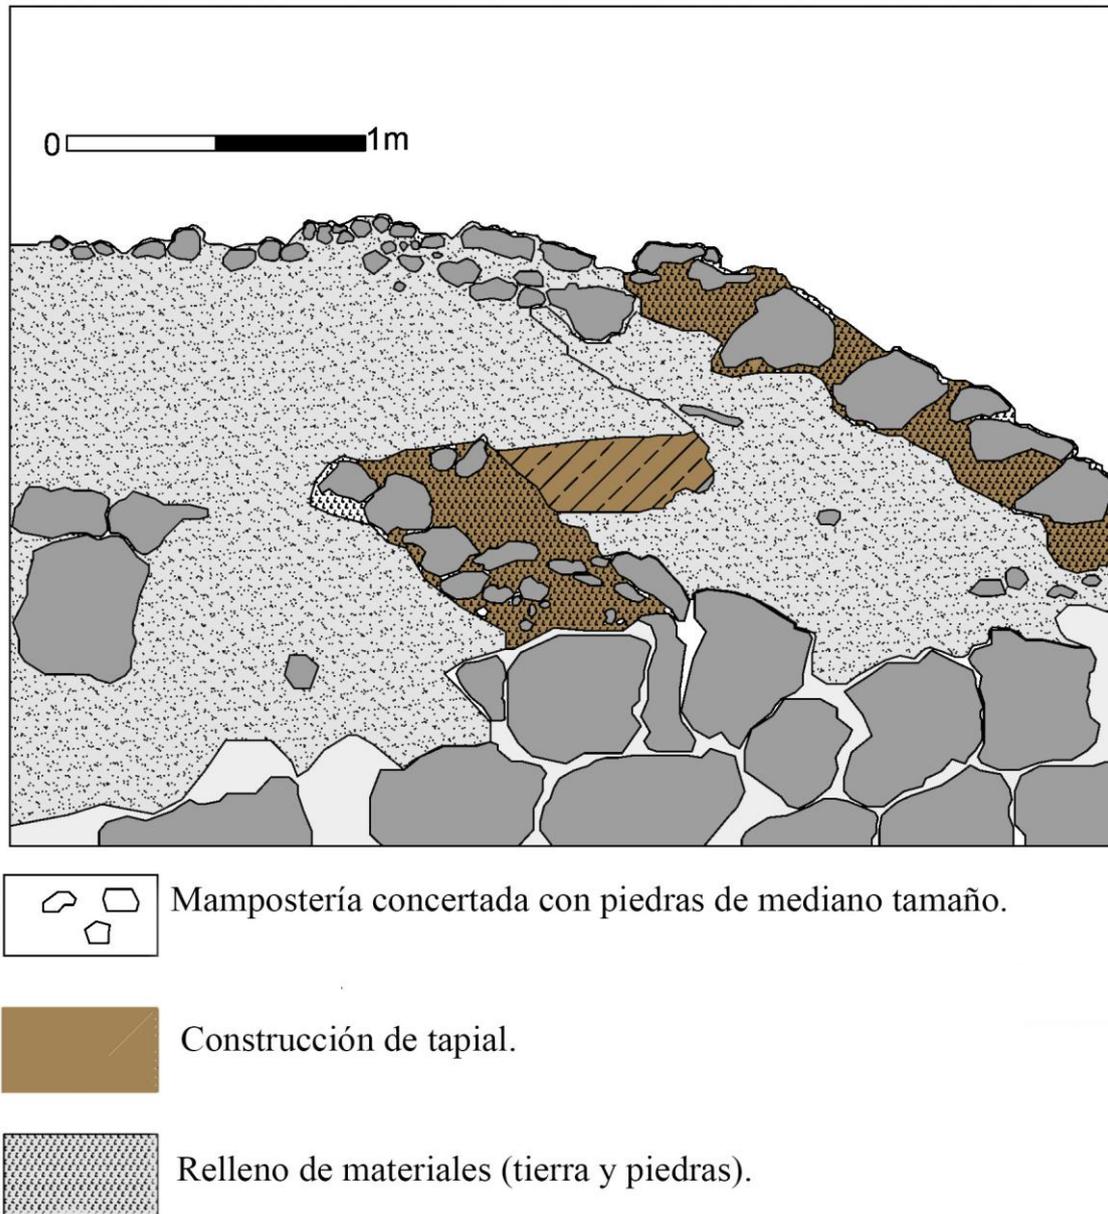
Detalle de la torre (T_13). La técnica constructiva, mampostería concertada y verdugada, sobre núcleo de tapial. (Elaboración propia).
